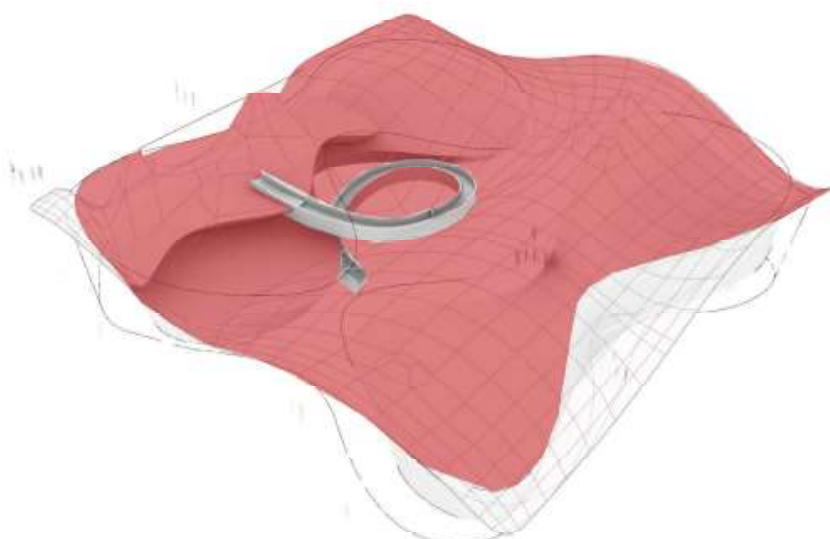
Formfindung, Dach, Verbindungsrampe
